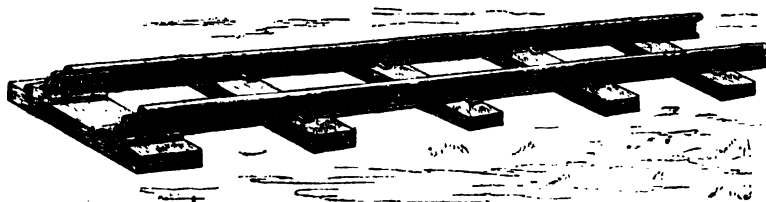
5 m langes Geleisstück mit Holzschwellen.
